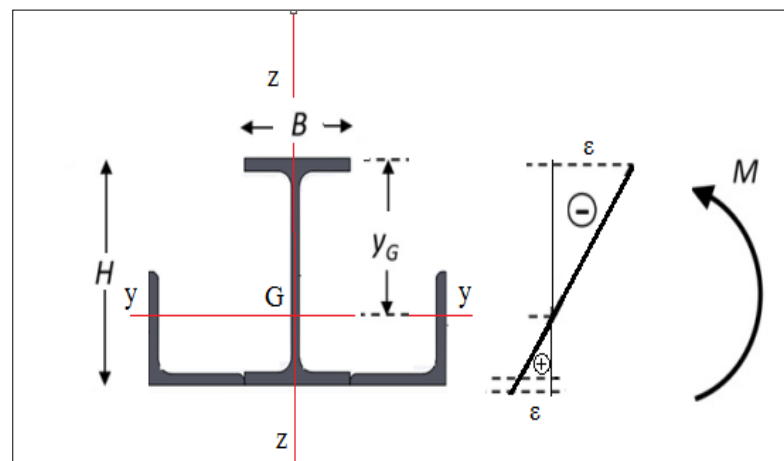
Section d'étude (Poutre en I renforcée avec 2 cornières)
